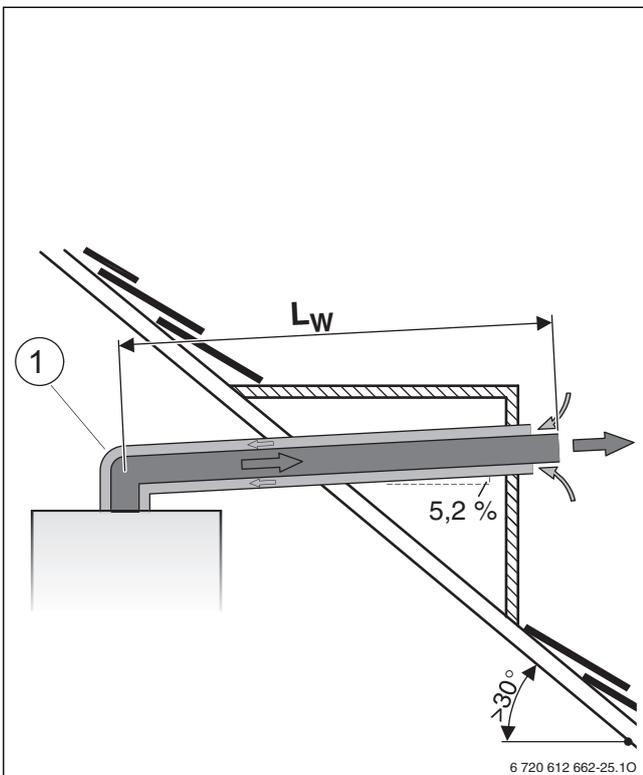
Abgasführung waagrecht nach C_{33x} (Ø 80/125 mm)
